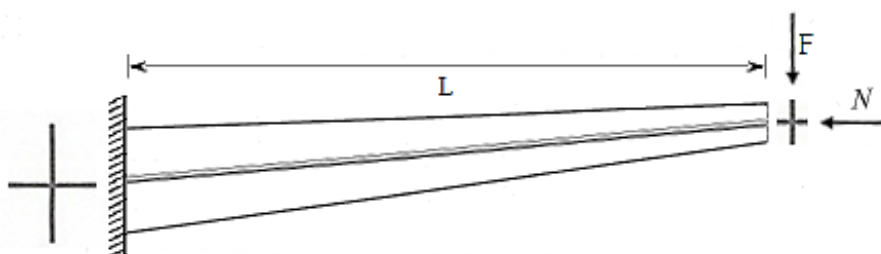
Elemento estrutural em consola com secção cruciforme não prismática
